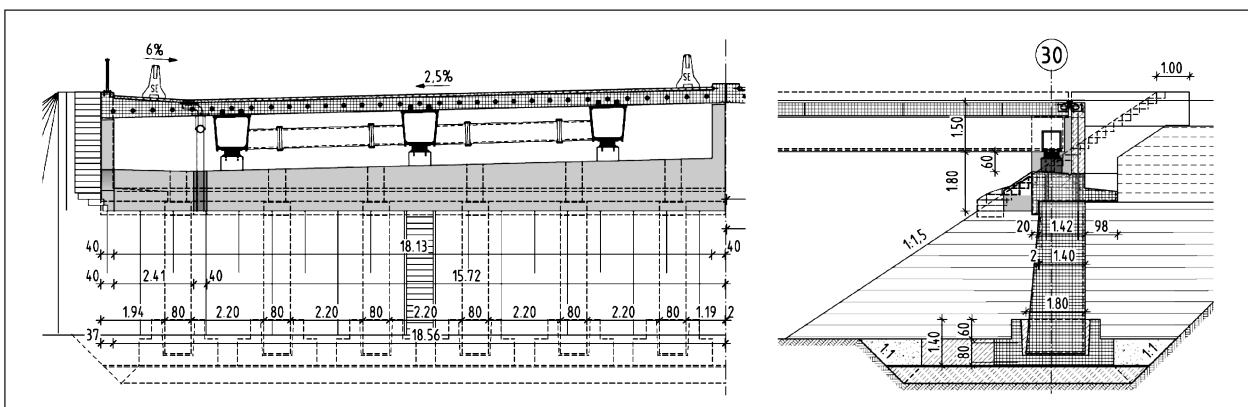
Detail – Widerlager, Ansicht und Längsschnitt
